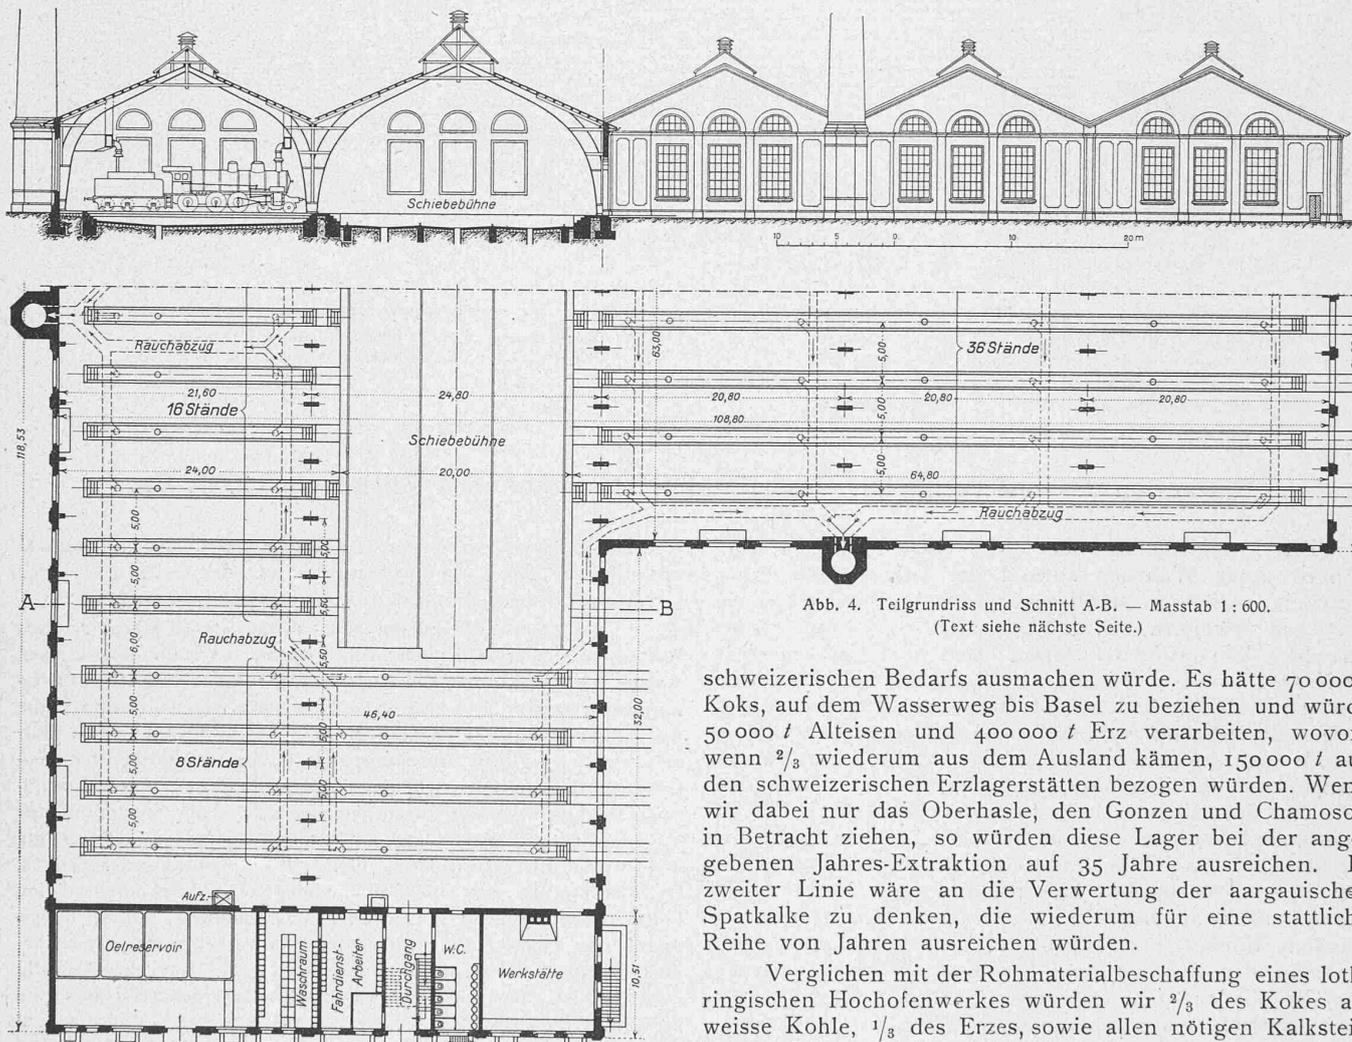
Teilgrundriss und Schnitt A-B. — Masstab 1 : 600.
